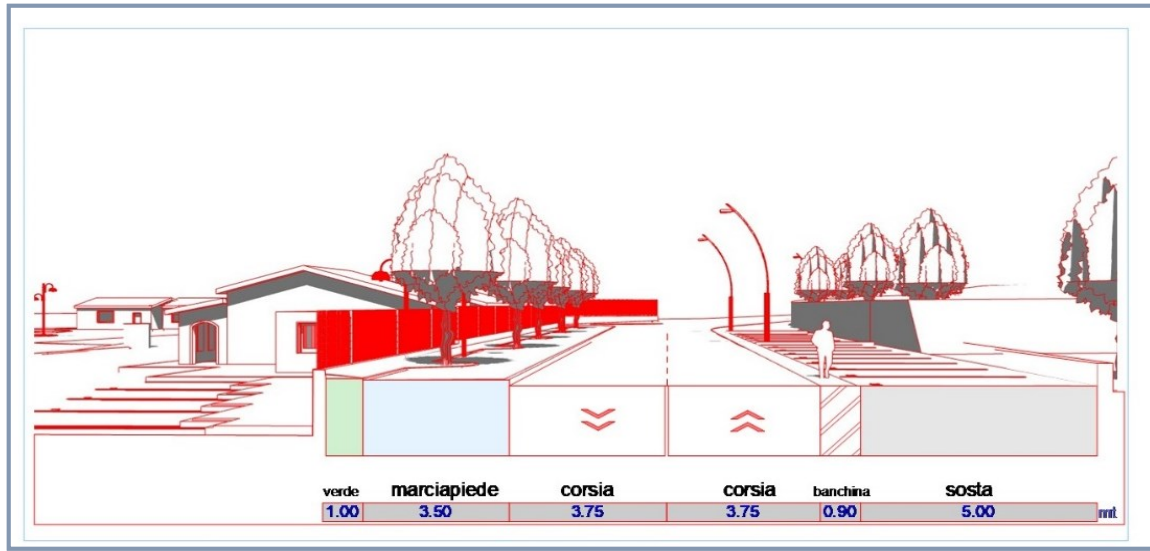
sezione prospettica di progetto di viale Raf Vallone
